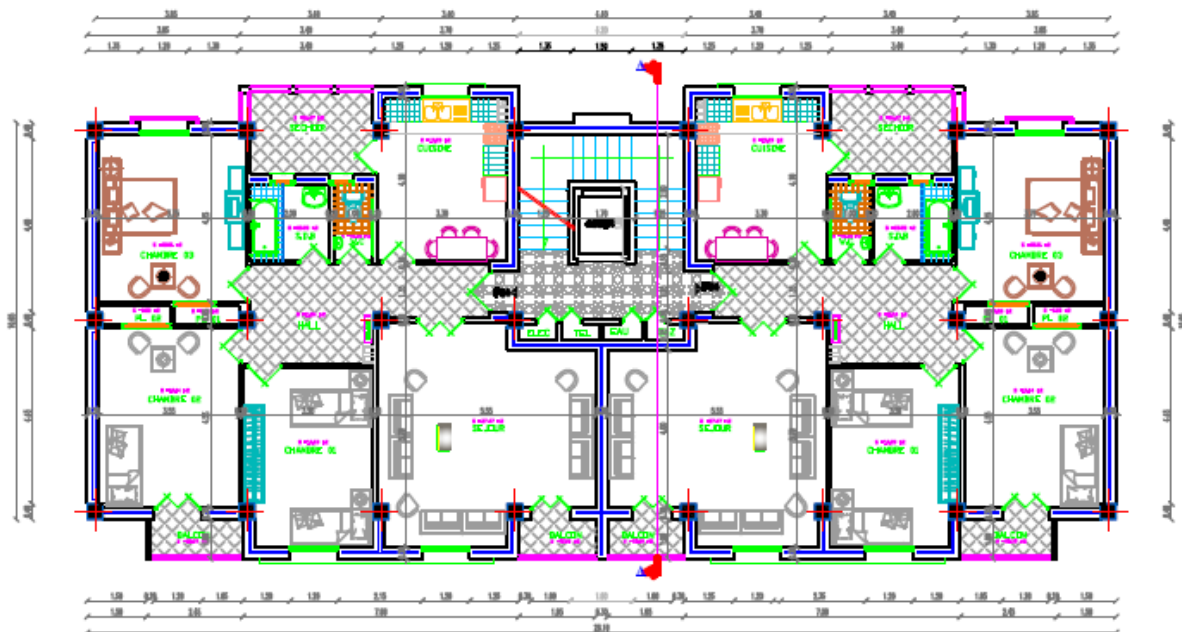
Plan étage (2ème, 3ème, 4ème, 5ème).
